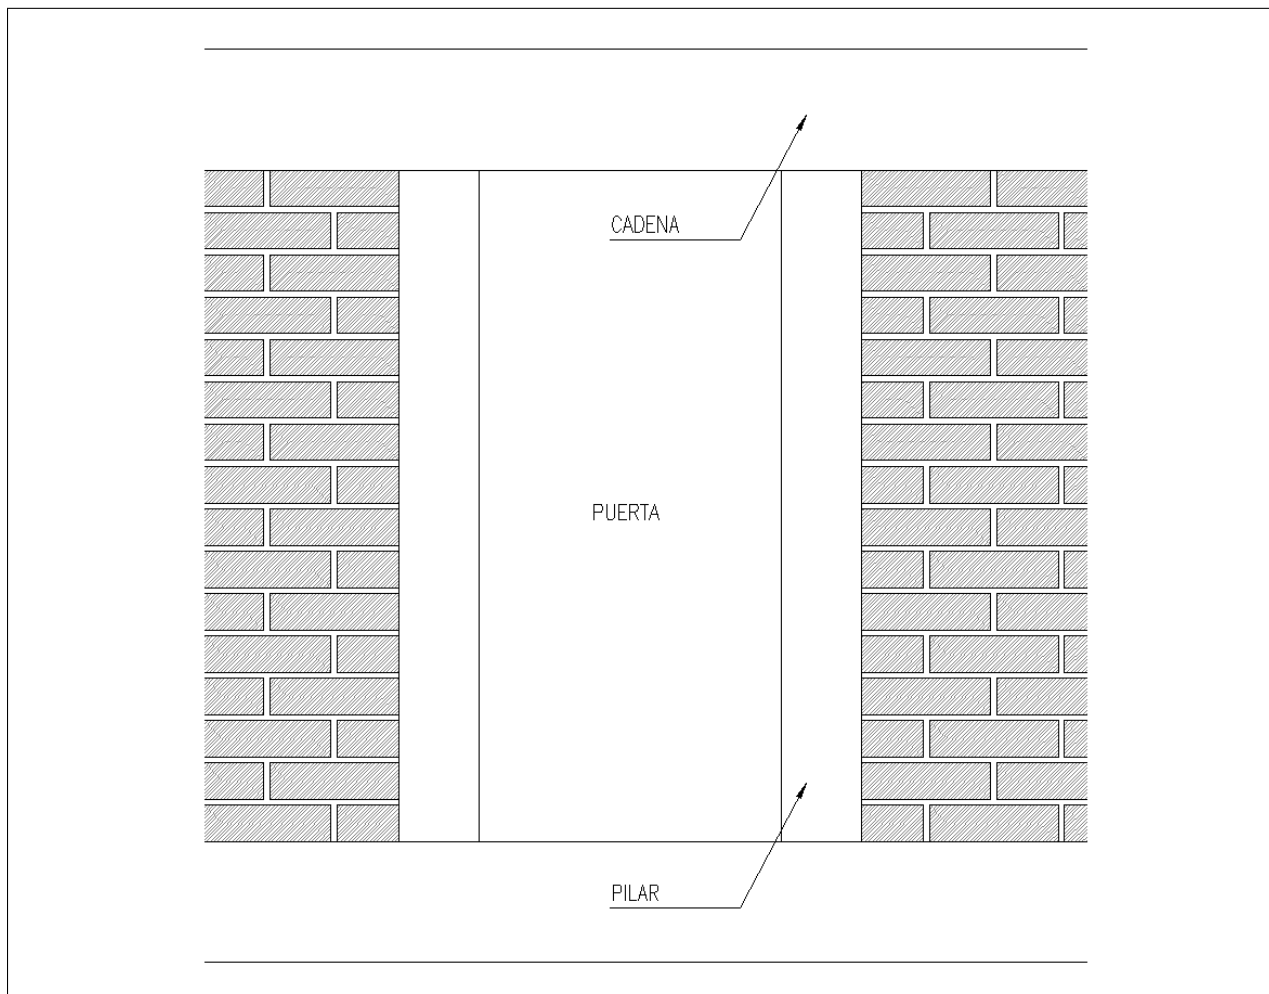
Refuerzo de una abertura de puerta con pilares de hormigón armado
